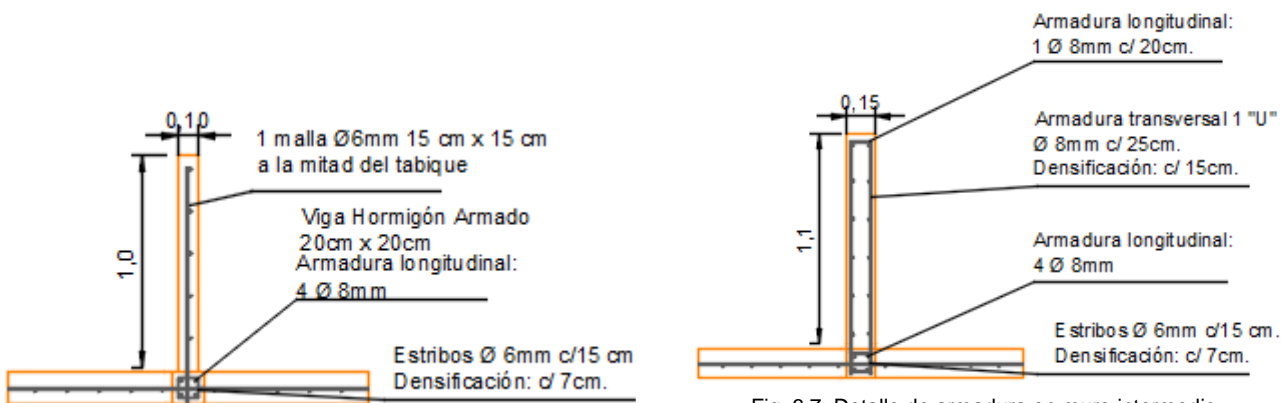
Detalle de armadura en pantallas deflectoras.
